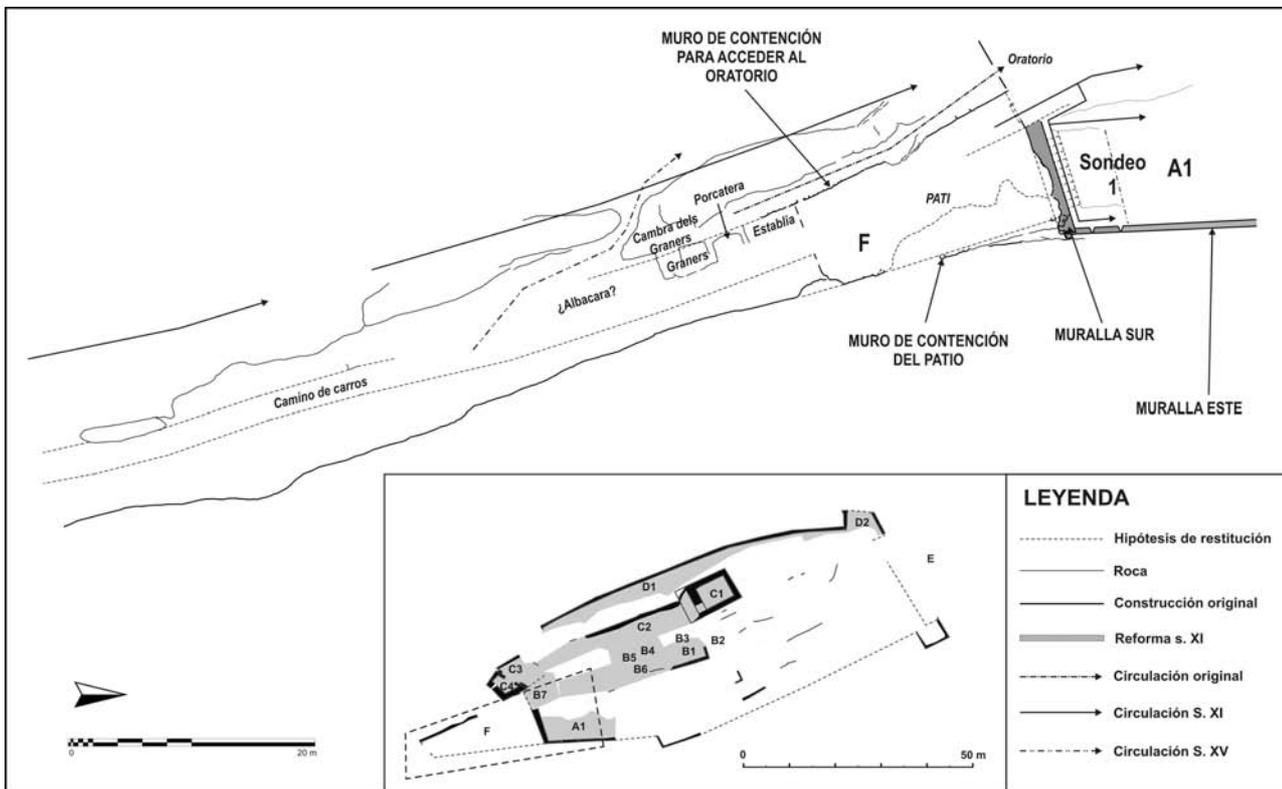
Excavación Sectores A1-B7-F (Entrada y muralla sur)
